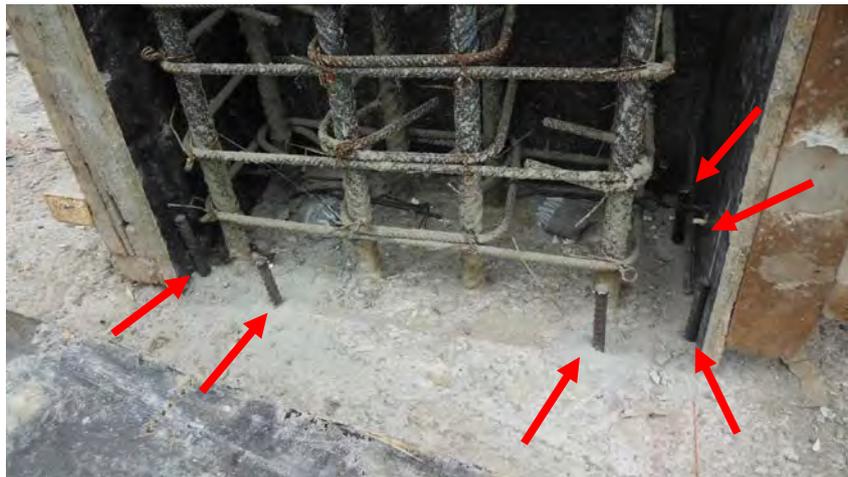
Barras ancladas en la losa como tope de encofrado de columnas.
